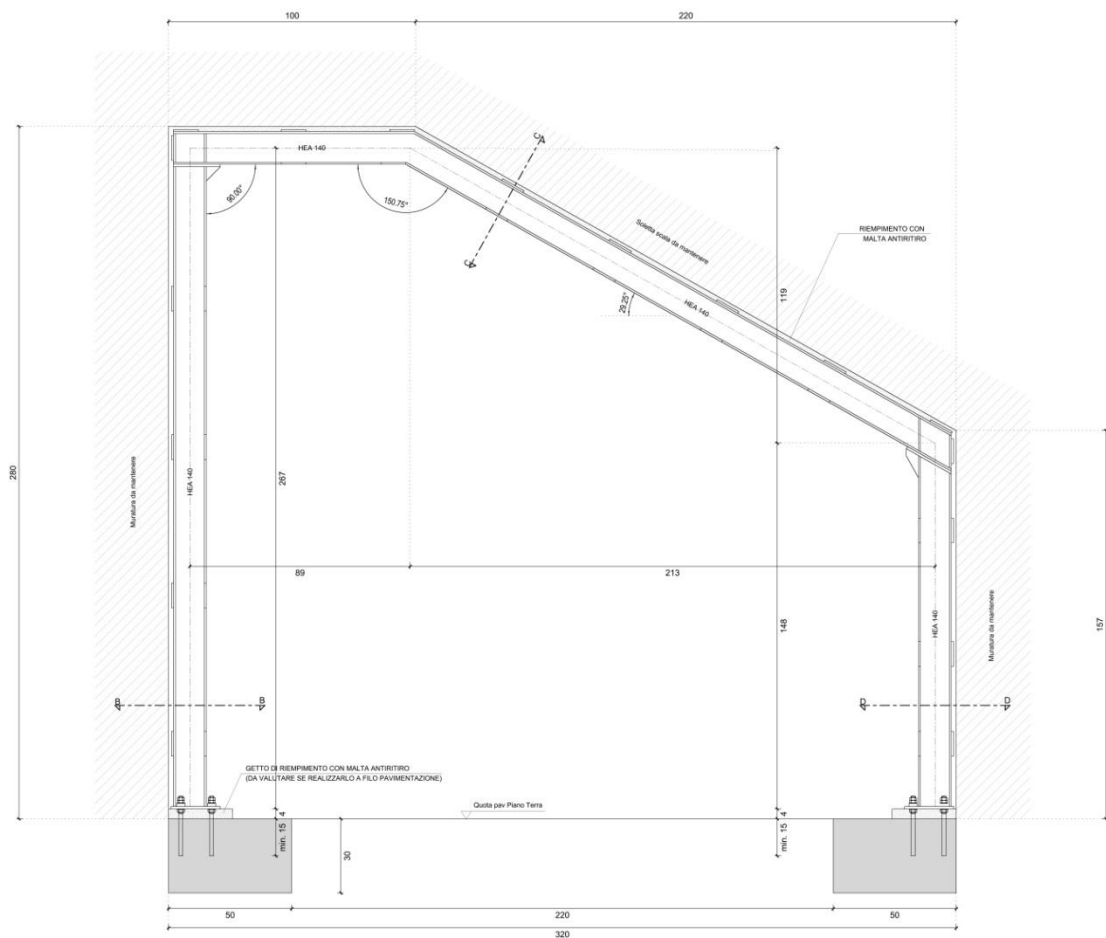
Particolare di A.2014.a.il.T01 - Telaio di sostegno scala cabina elettrica - Prospetto
